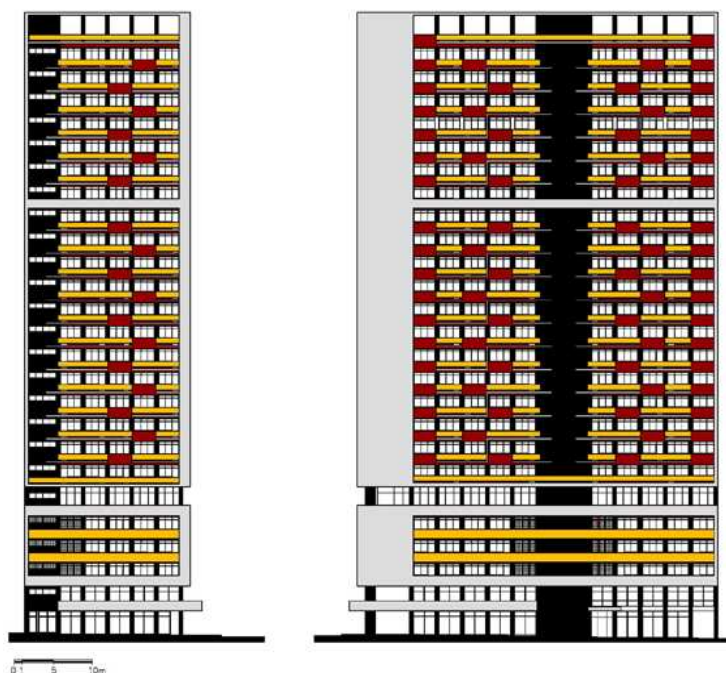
Fachada leste, Rua Vigário José Inácio e fachada norte, Av. Salgado Filho.
